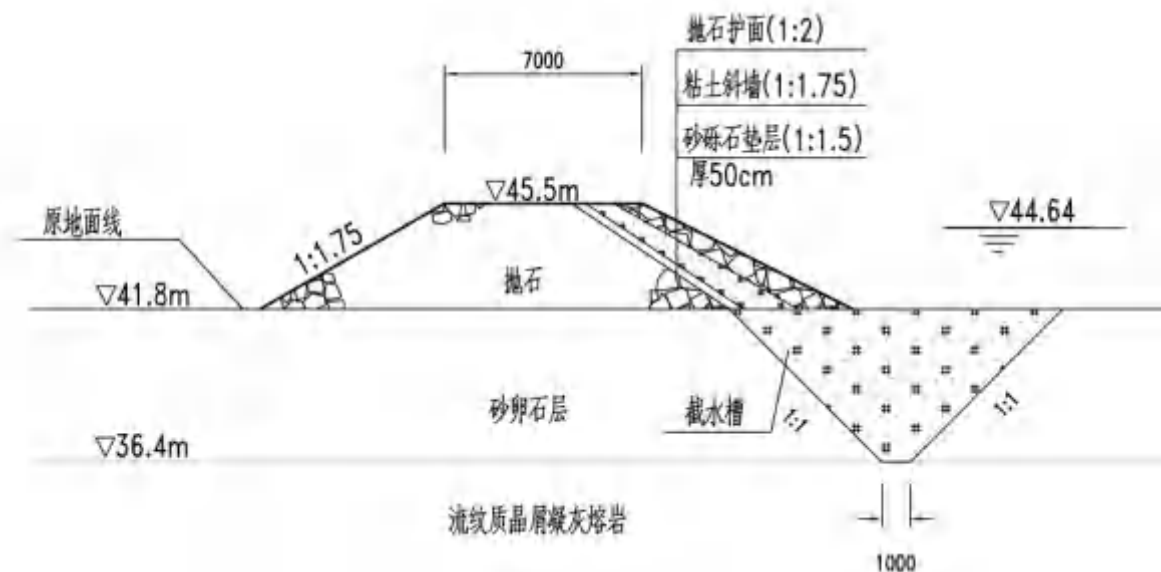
下游围堰典型断面图 单位：高程 m，其余 mm
